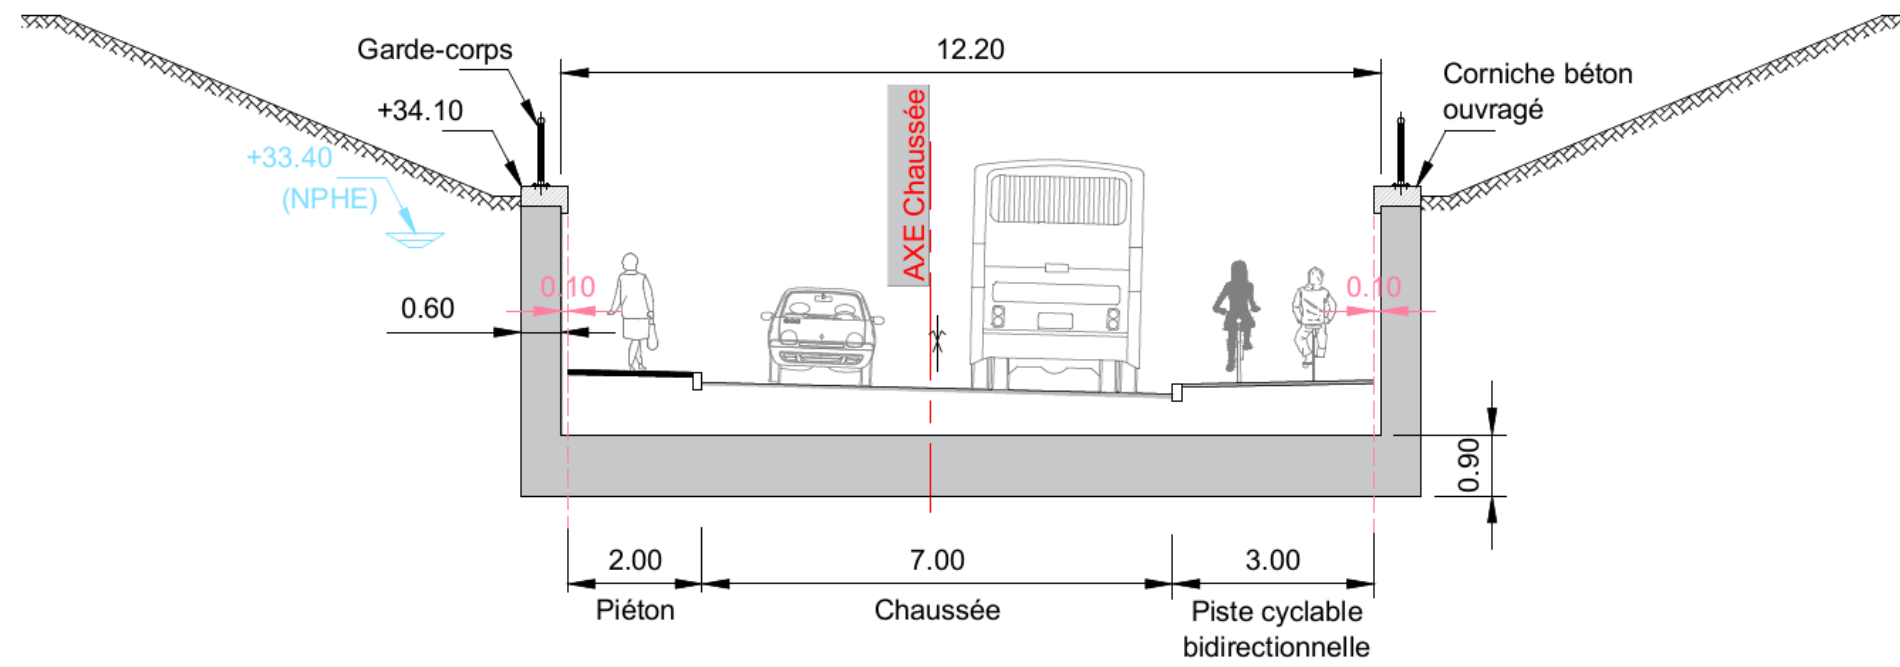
COUPE TRANSVERSALE SUIVANT L'AXE DU PRO
